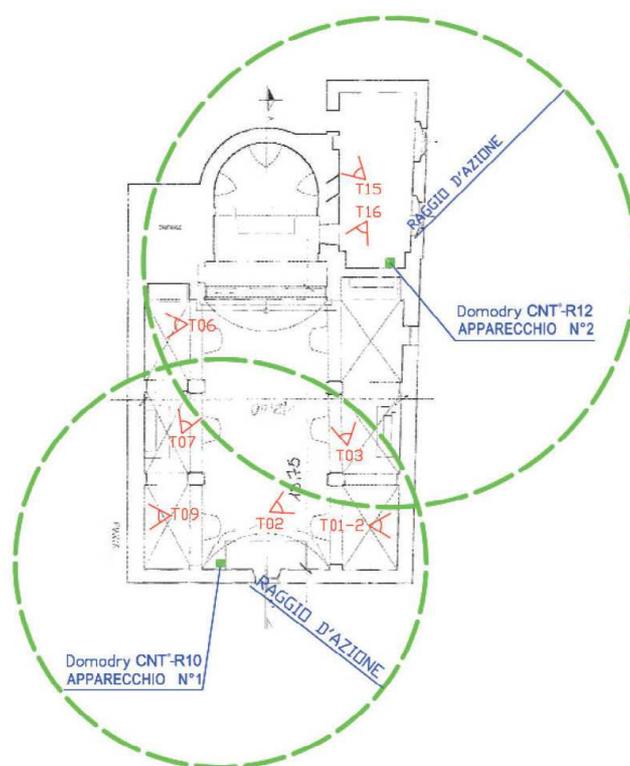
Schema planimetrico dei dispositivi CNT installati nel settembre 2012
